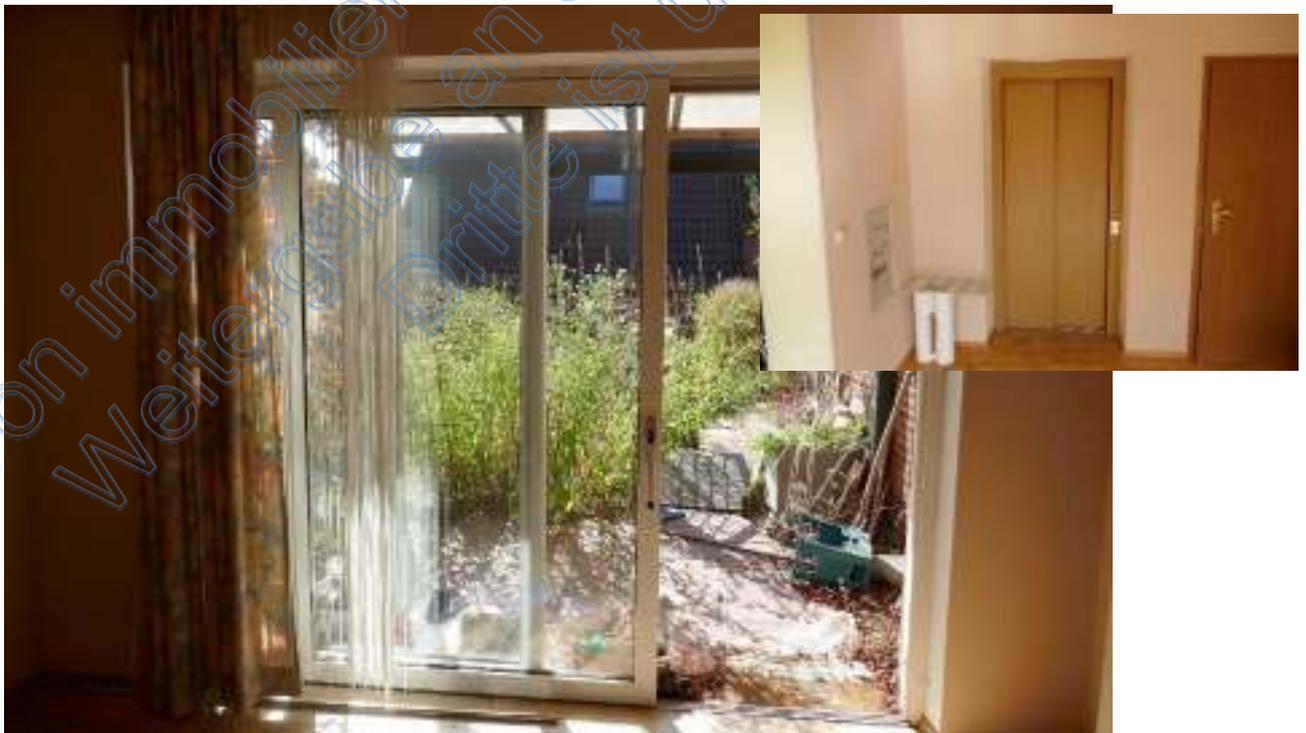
, EG, Ostanbau, Diele, Blick zur kleinen überdachten Terrasse 2, kleines Foto Erdgeschoss-Station des Aufzugs in der Diele
